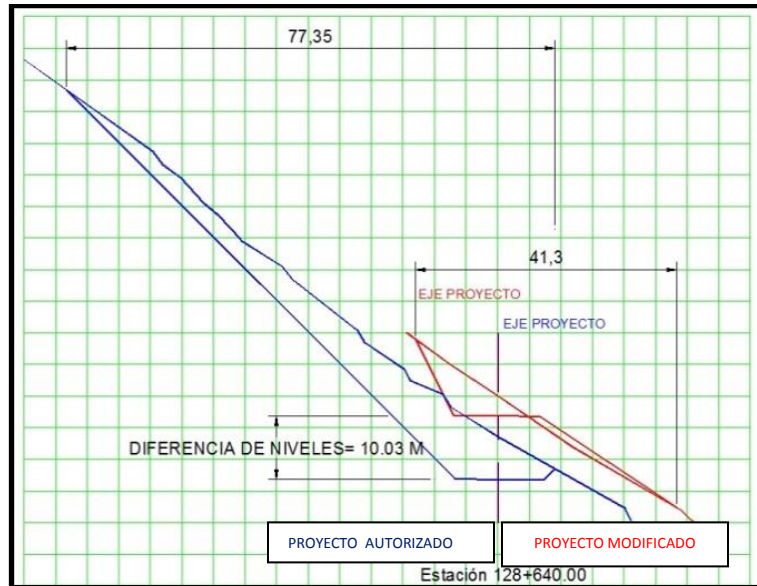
Comparación de sección proyecto autorizado - sección proyecto modificado se da mayor estabilidad, a base de la configuración del terreno físico.
